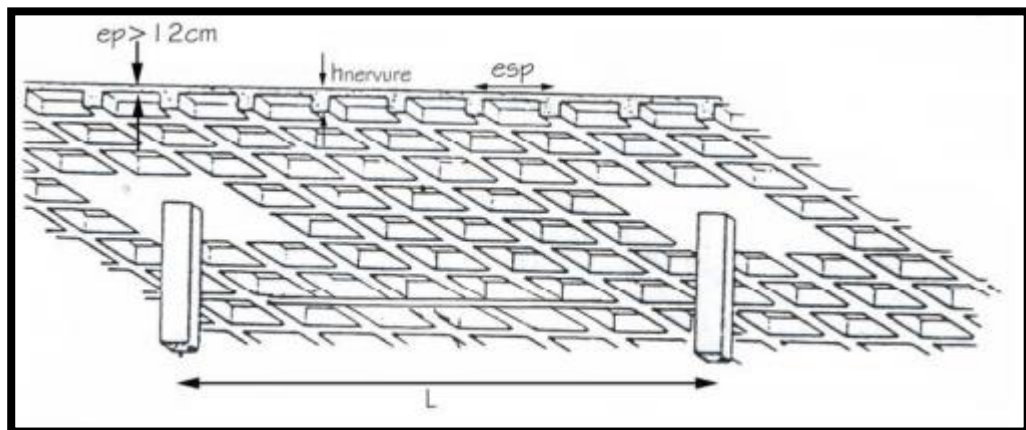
dalle à caisson bidirectionnelle. Source : Cours construction Mr.Lemdani
